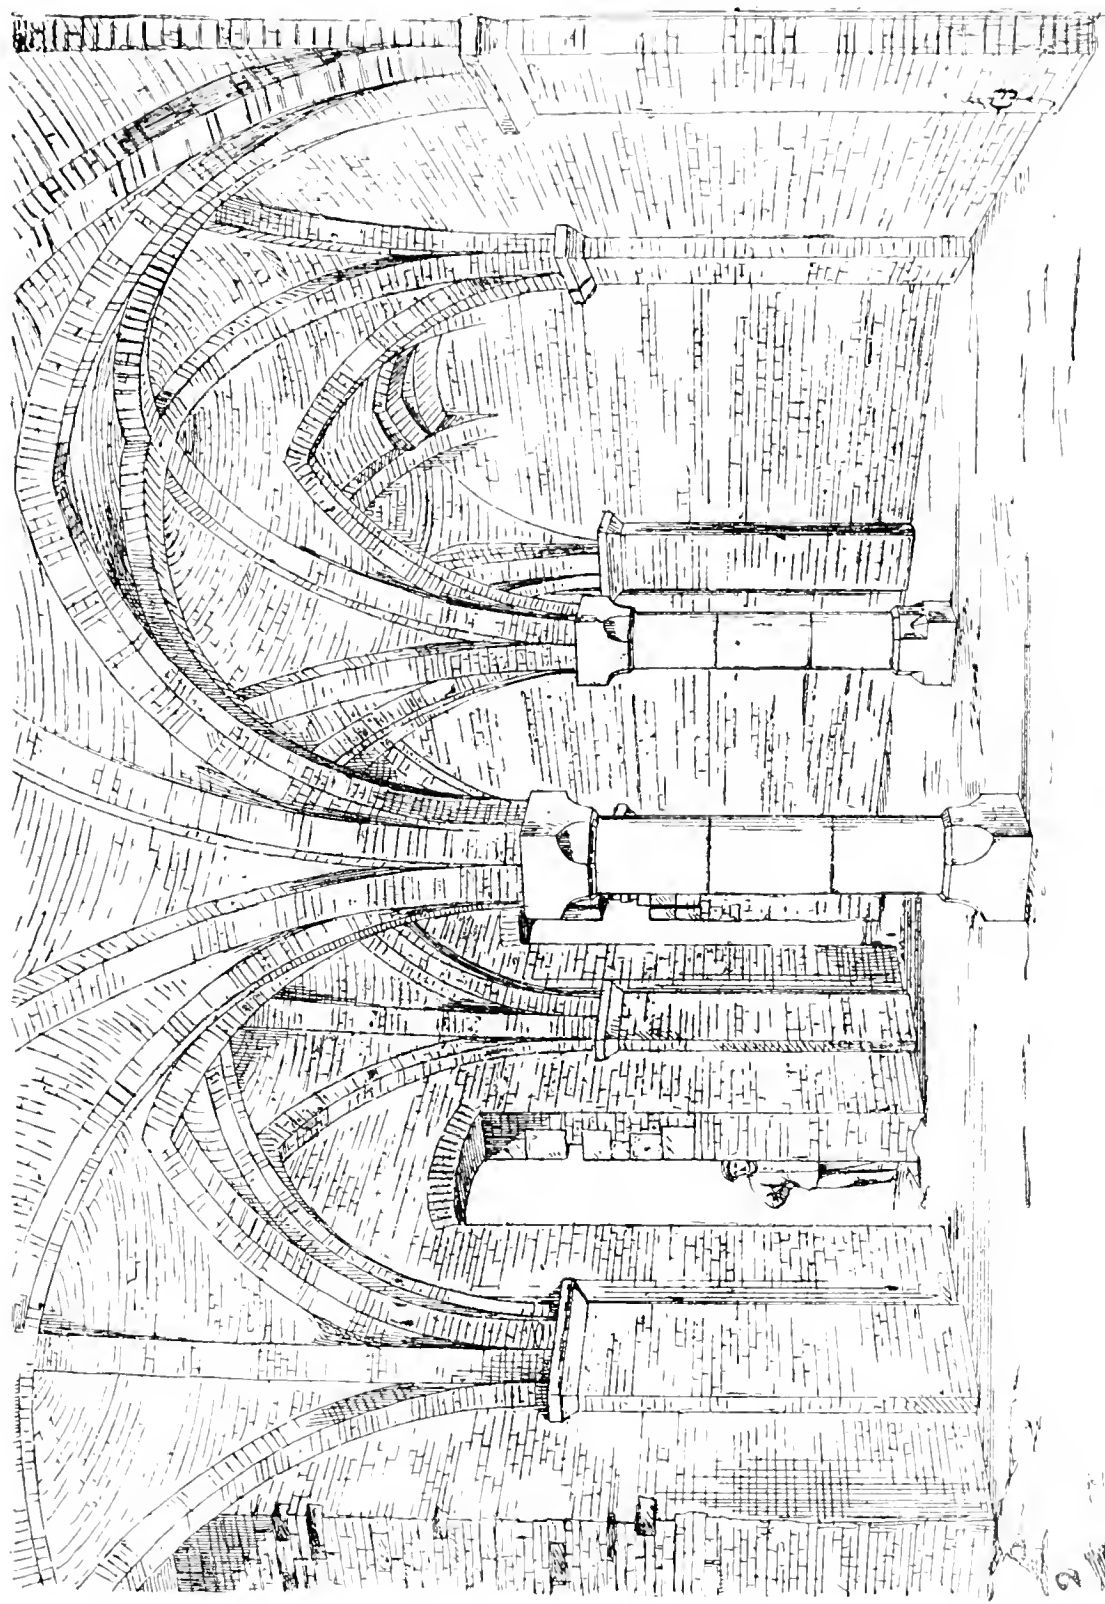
Salle du rez-de-chaussée (état à la démolition).
